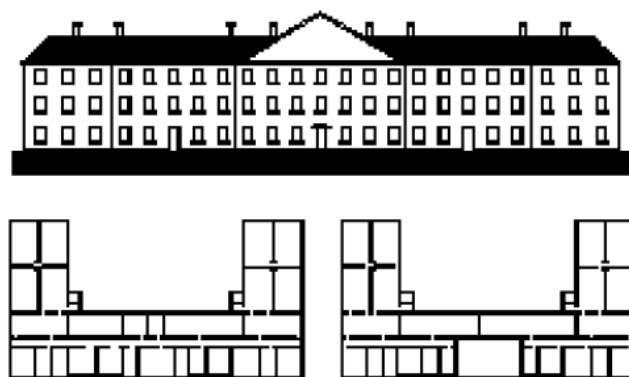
Elevação e plantas do térreo (abaixo, esquerda) e do primeiro piso do London Hospital.
